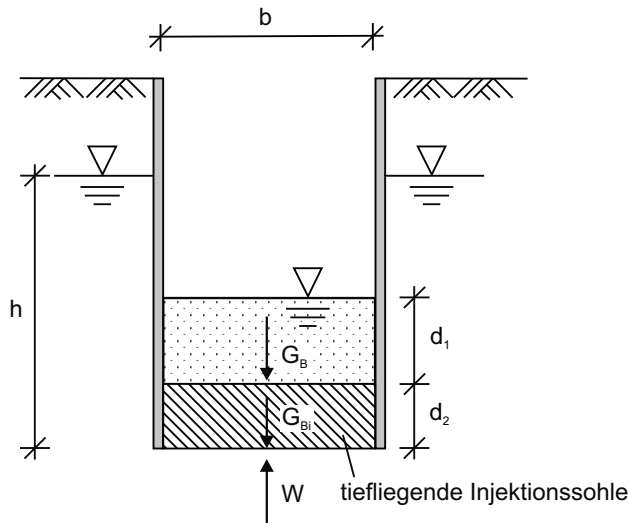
Nachweis gegen Aufschwimmen im Grenzzustand UPL am Beispiel einer Baugrube mit tiefliegender Injektionssohle
